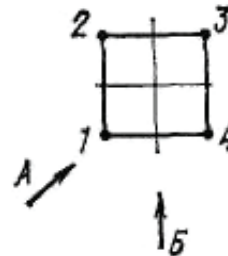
Схемы наиболее опасных направлений ветра: А - при расчете поясов; Б - при расчете решетки для башен.
